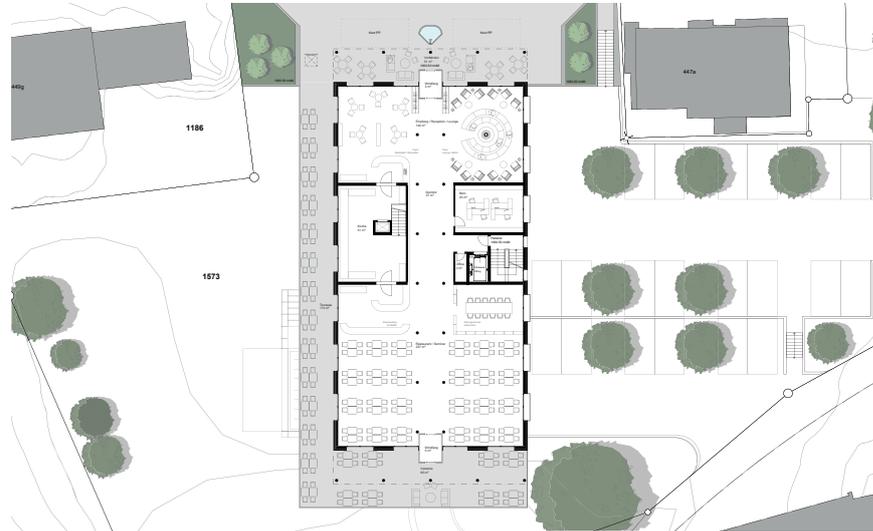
Situation mit Geschoss auf Niveau Kantonsstrasse mit Veranda und 20 offene Fahrzeugabstellplätze auf zwei Parkplatzniveaus mit separaten Zufahrten zvg baulink AG
